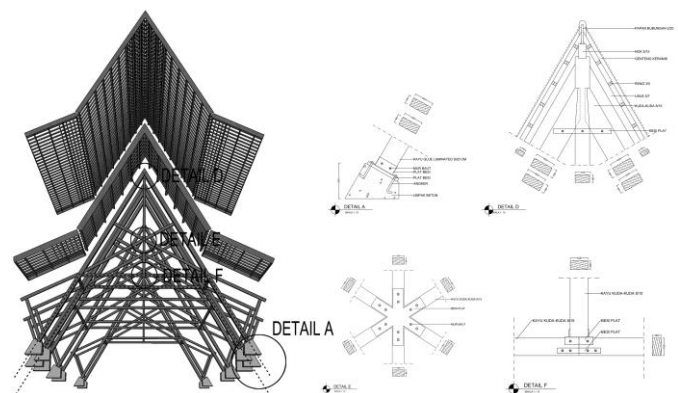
Tampak Samping Struktur Batik Shop yang Berlantai 3
